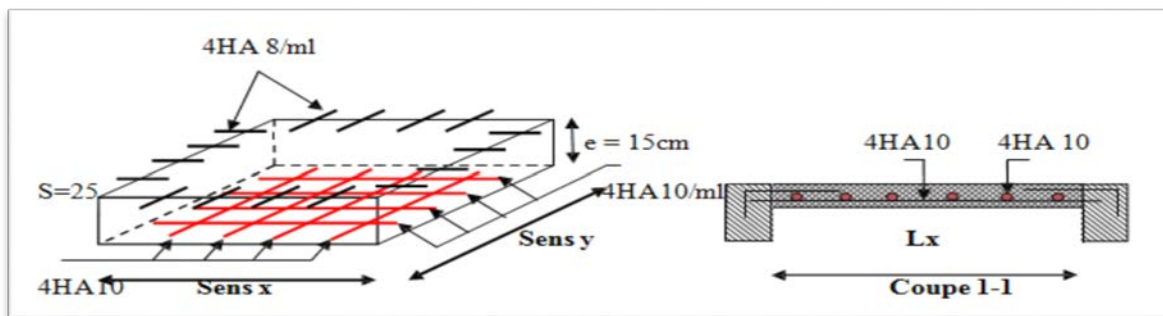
Schéma de ferrailage de la dalle sur 3 appuis.
